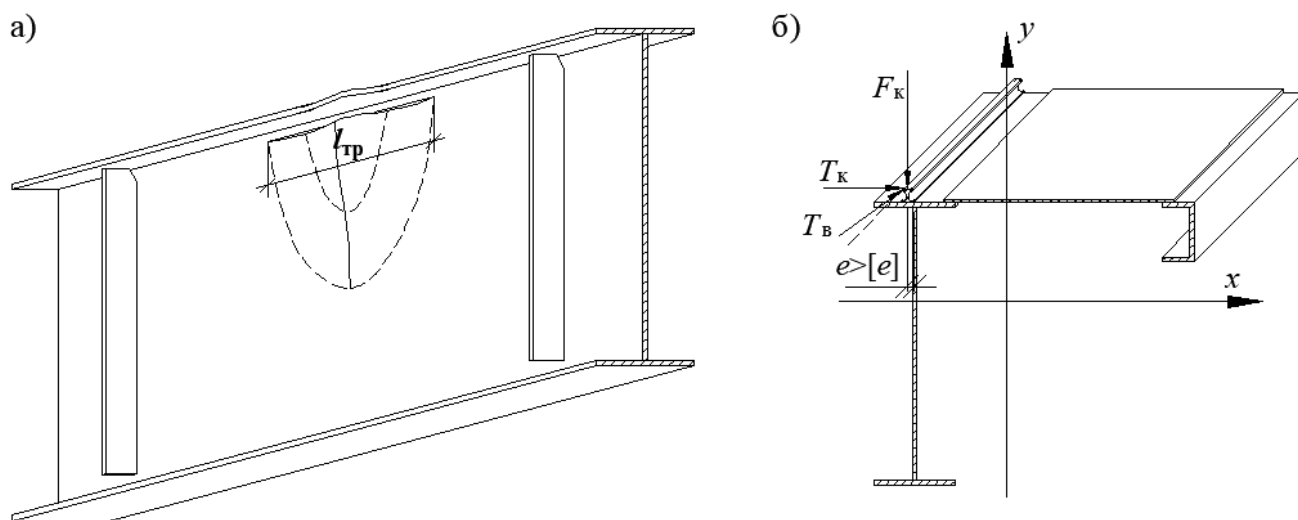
Схема подкрановой балки: а) фрагмент с усталостной трещиной в стенке; б) действующие нагрузки
